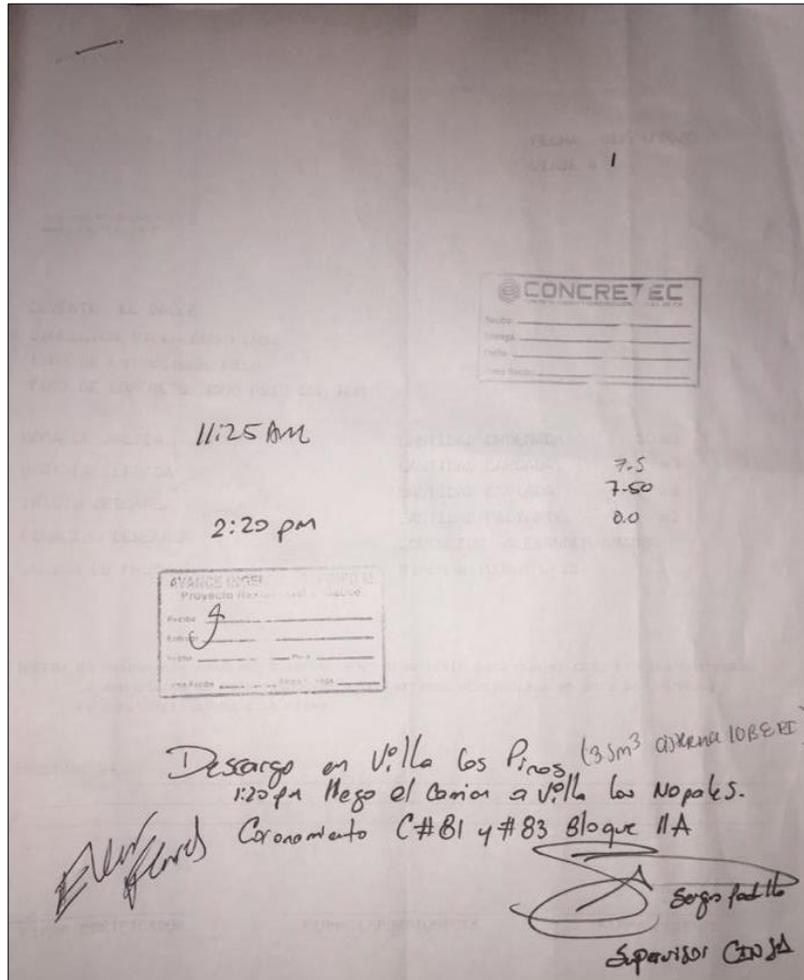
Información de descarga del concreto enviado por CONCRET E.C
